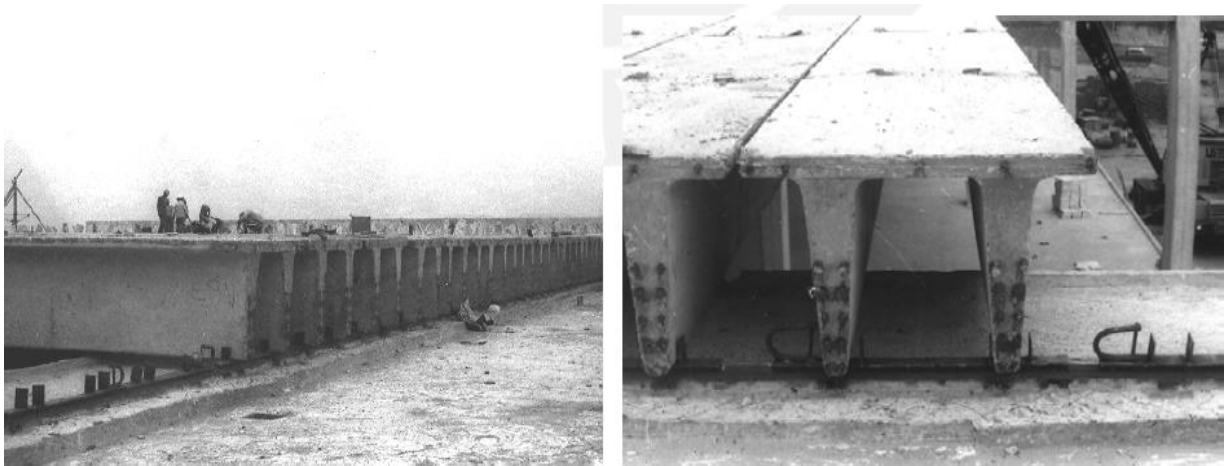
Montaje de vigas doble T pretensadas del centro comercial Higuiereta
